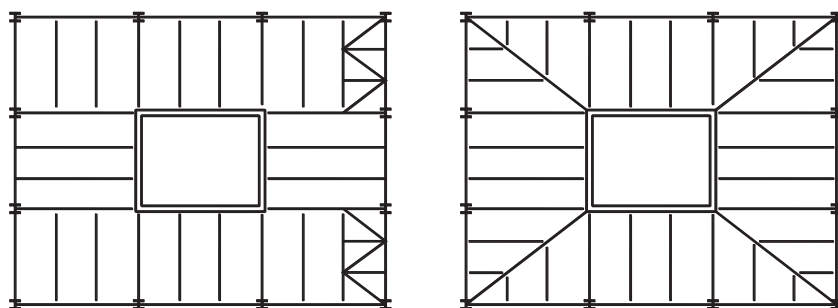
Балочные перекрытия каркасных зданий со стволом жесткости
